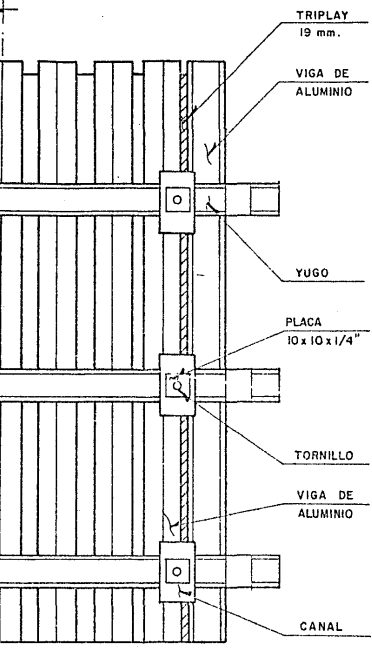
CIMBRA EN COLUMNAS C-27 ;
